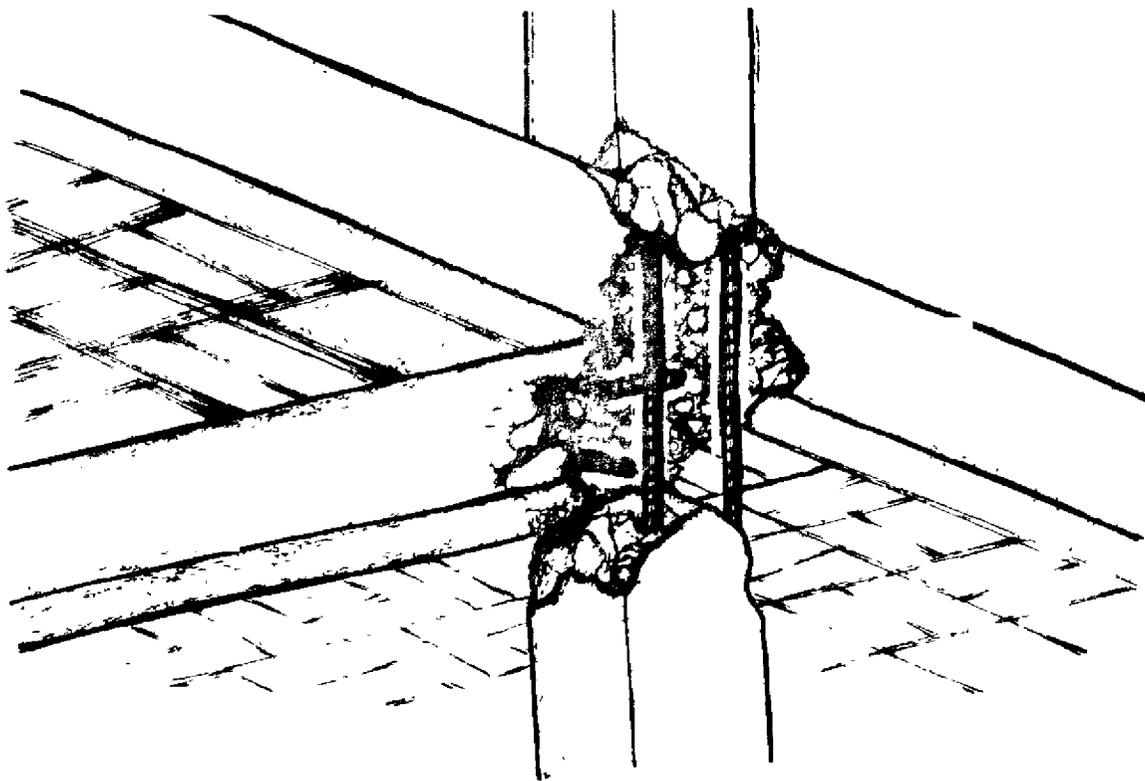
Alta rigidez del elemento viga-losa con relación a la columna
